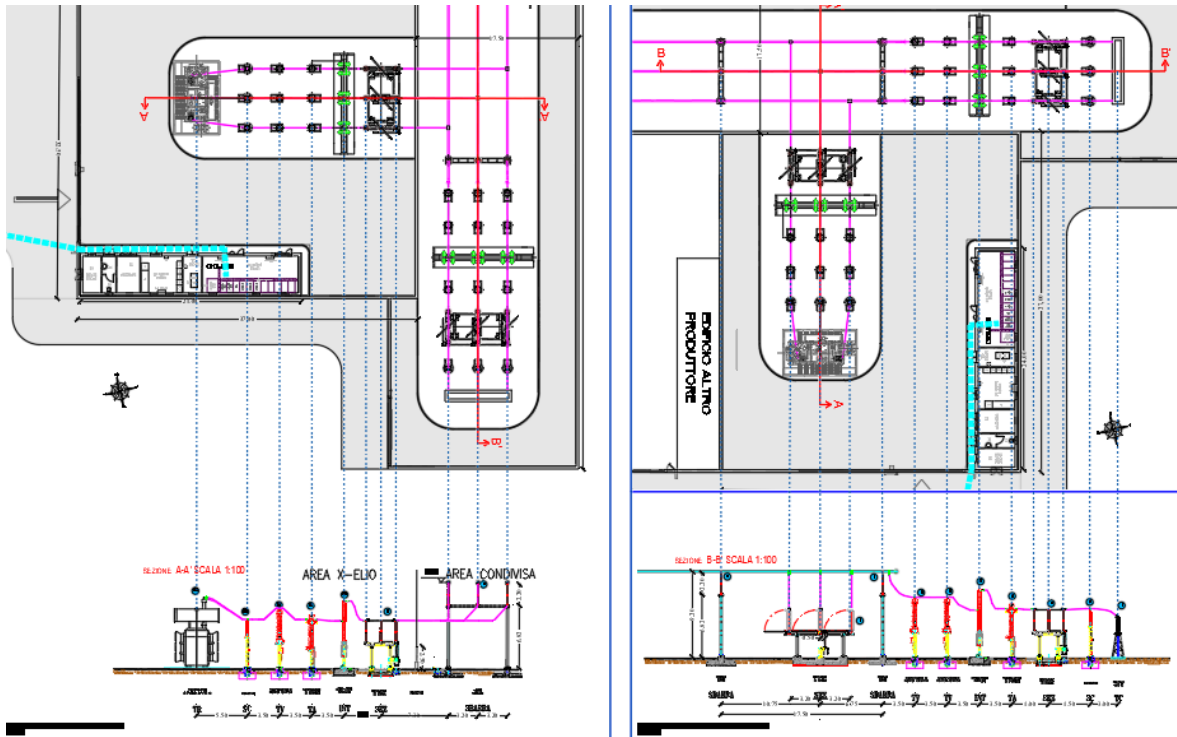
Planimetria e sezioni apparecchiature elettromeccaniche
